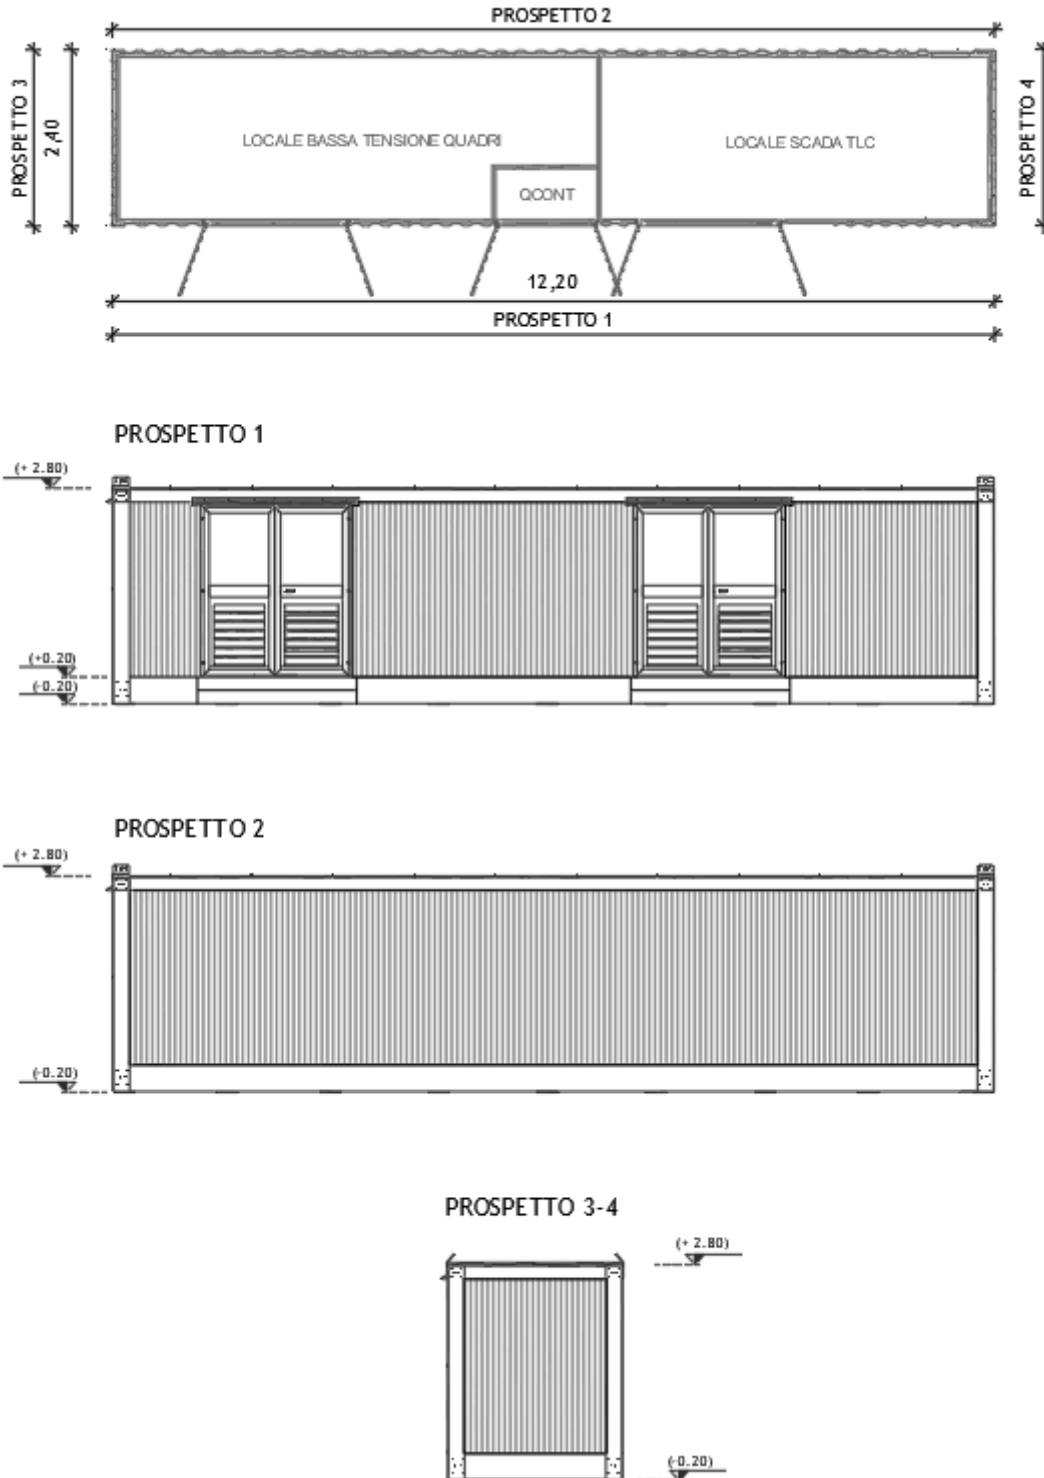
Pianta e prospetti dell'edificio BT + SCADA e TLC della cabina di consegna
